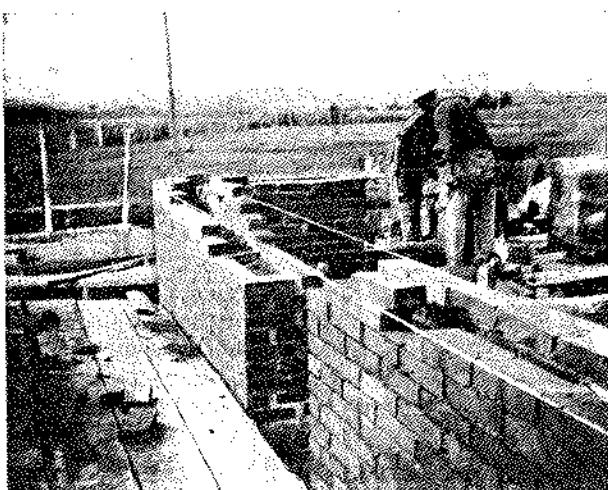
Кладка герардовских стен в опытном строительстве Ин-та сооружений.
